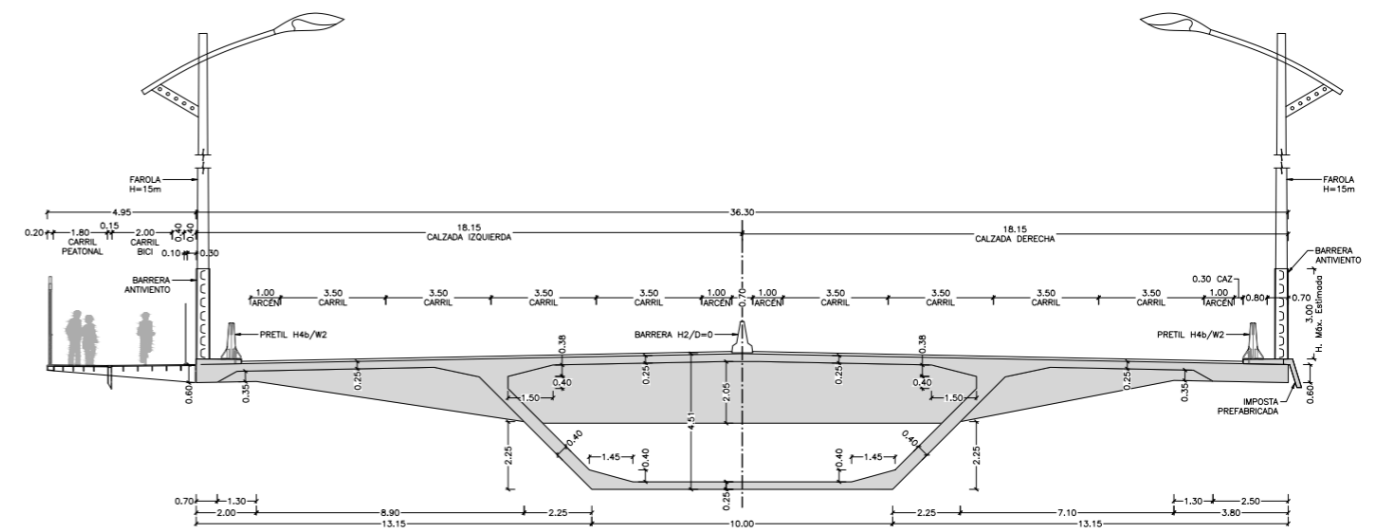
Viaductos de acceso. Sección tipo de ancho mínimo por costilla transversal
